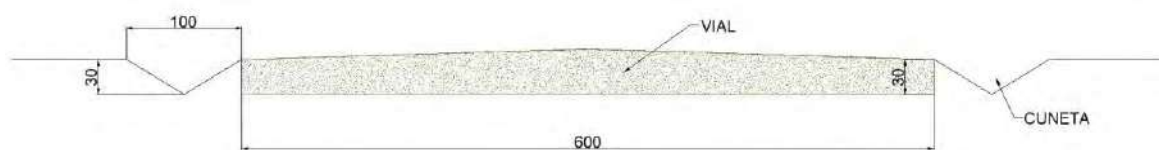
Sección transversal vial principal (Fuente: propia Elaboración: propia)
